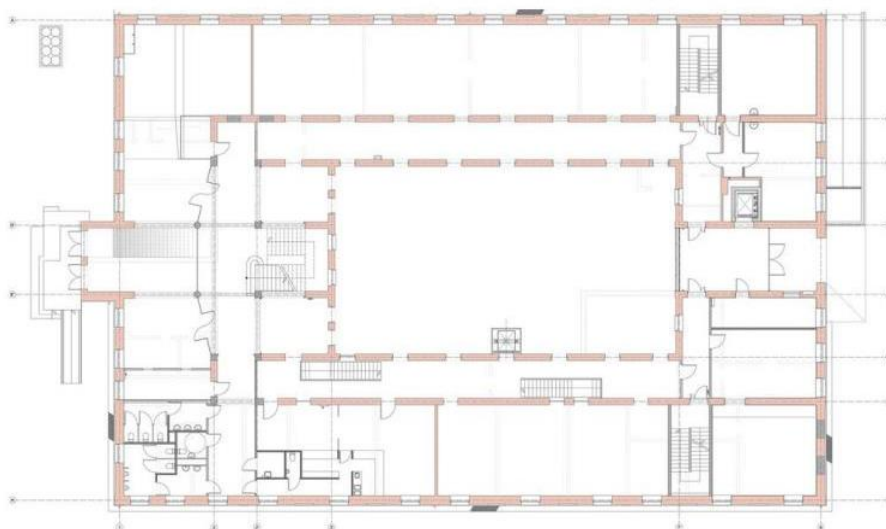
Музей «Армии Крайовой» План 1 этажа [2].
